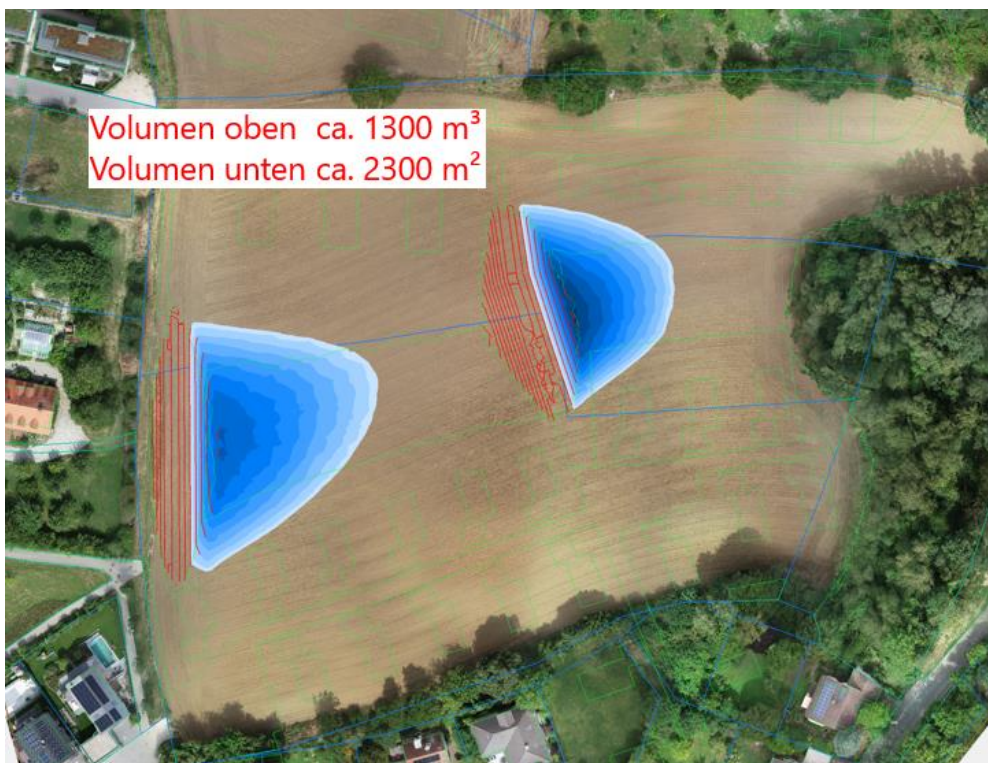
Dammflächen und Wasserflächen für zwei Regenrückhaltebecken
